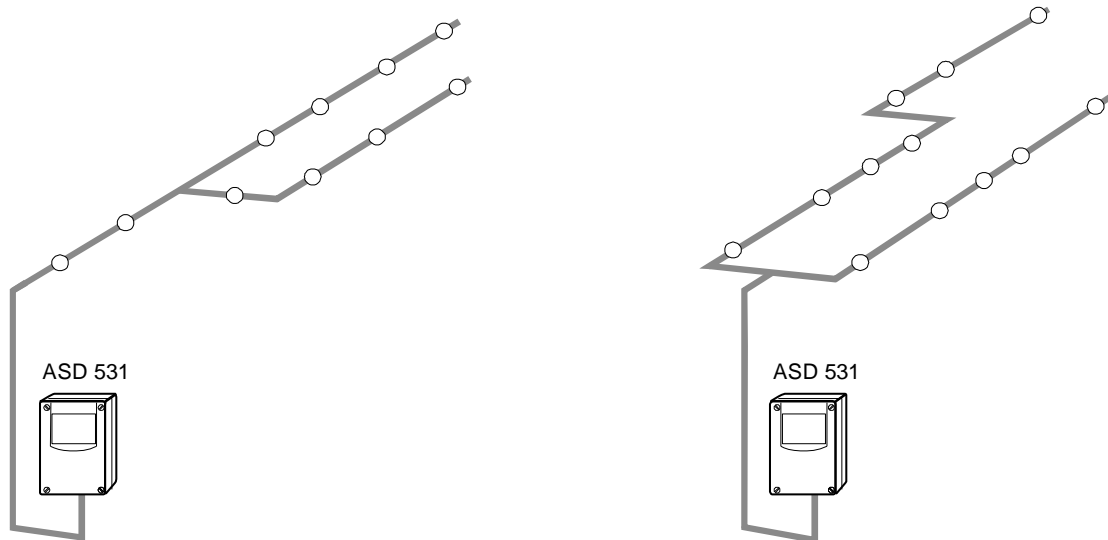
Примеры планирования с расчетом ASD PipeFlow
